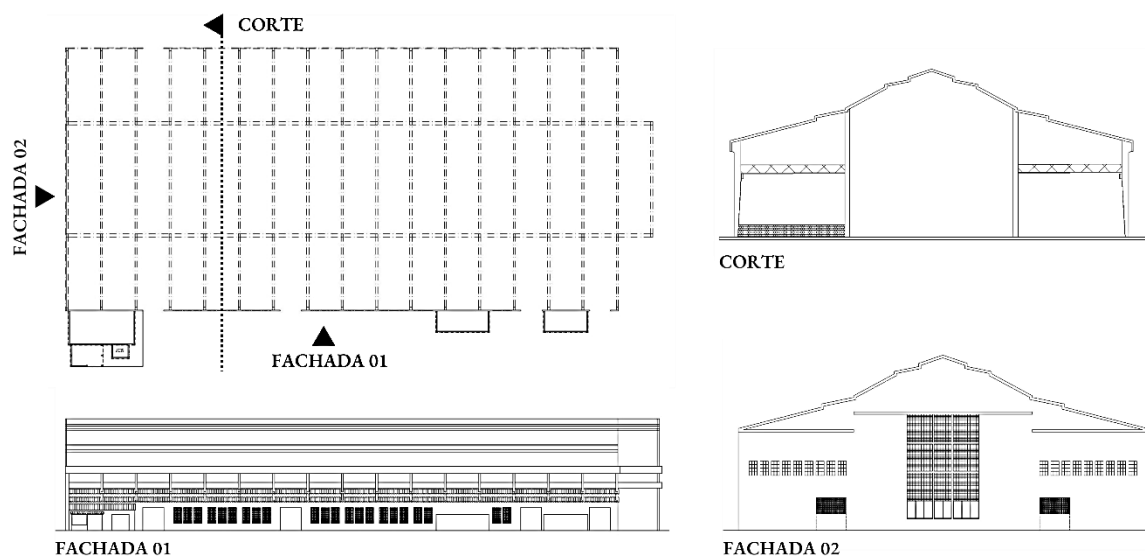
Planta baixa, fachadas e corte da oficina de montagem e reparação de locomotivas. Fonte: Levantamento e desenho elaborado pela autora (2022).
